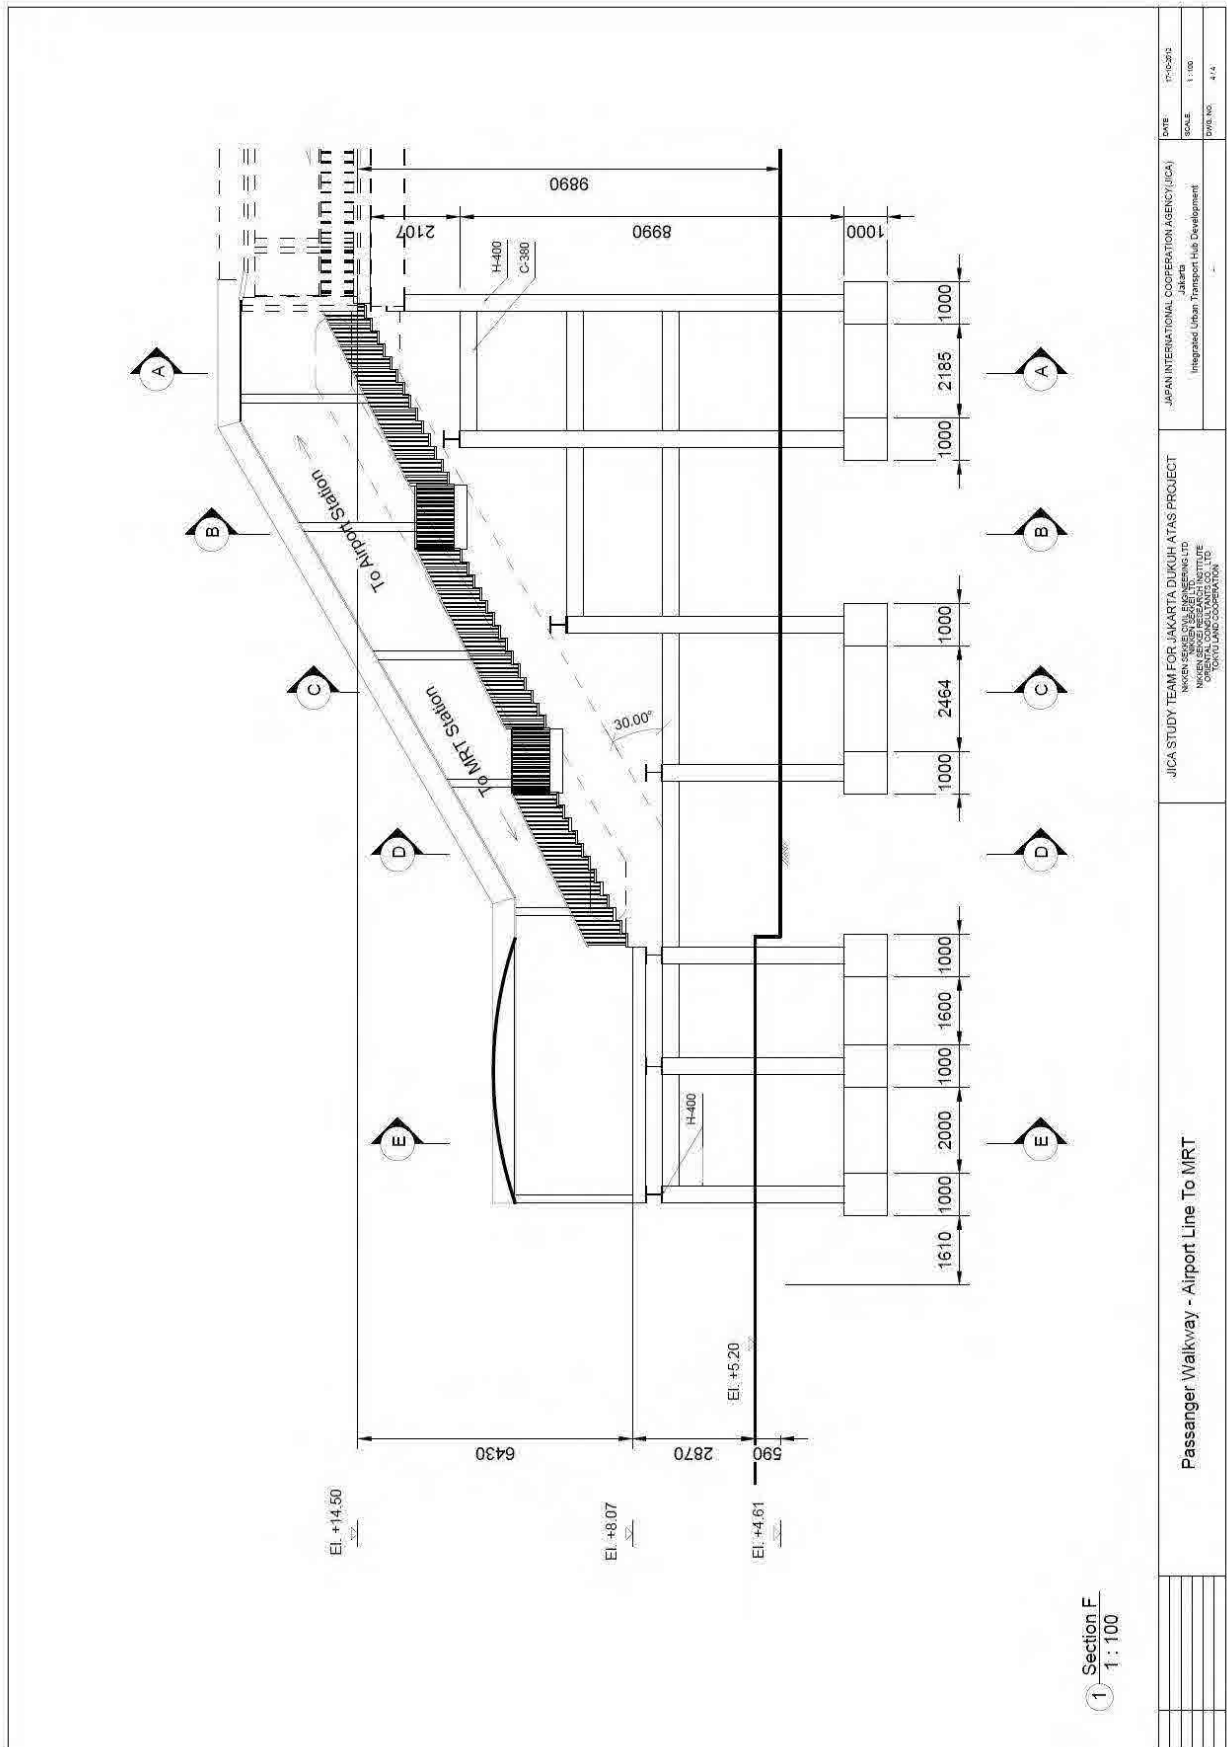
空港線-MRT 南北線連絡通路階段断面図 (その1)
